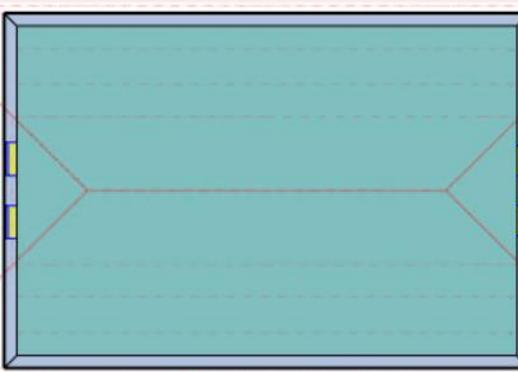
Grundriss Dachgeschoss, zoniert
